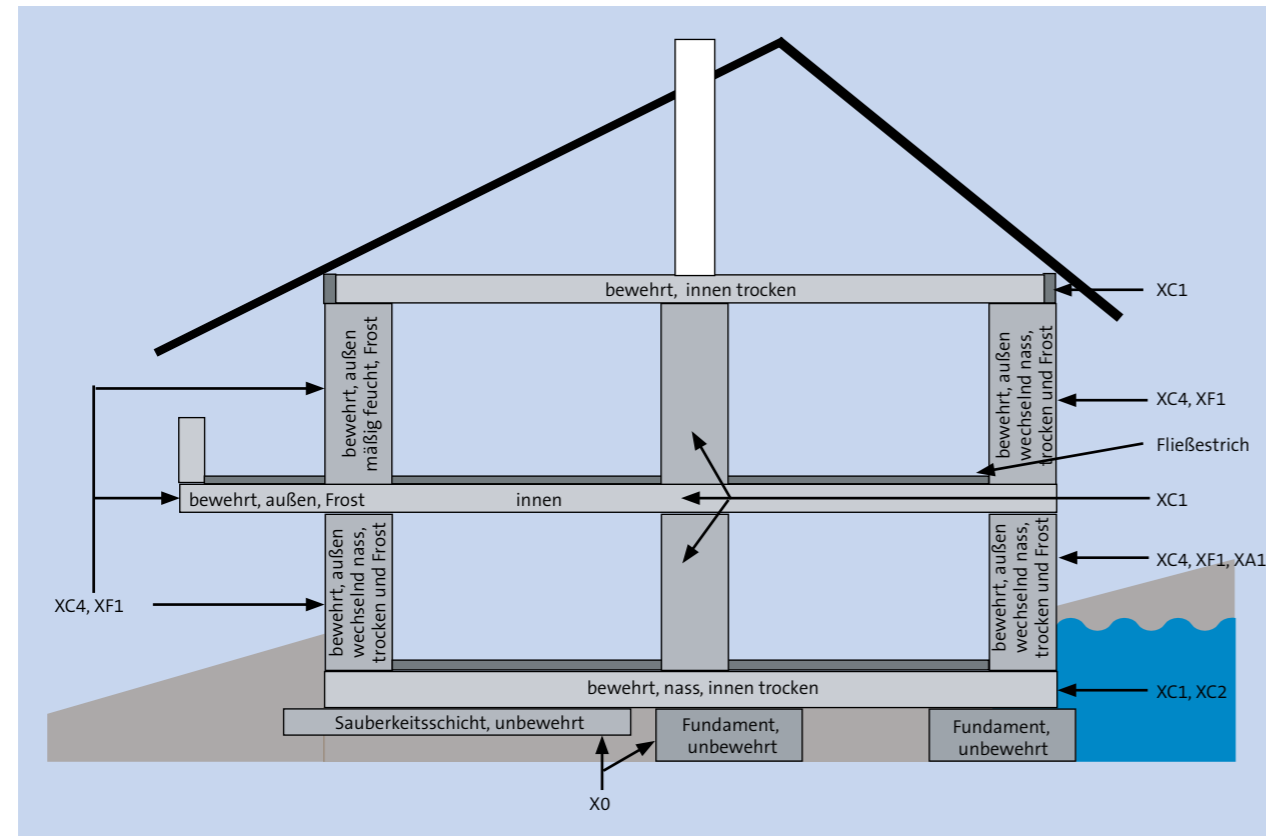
Expositionsklassen am Beispiel einer Prinzipskizze für den Hochbau
